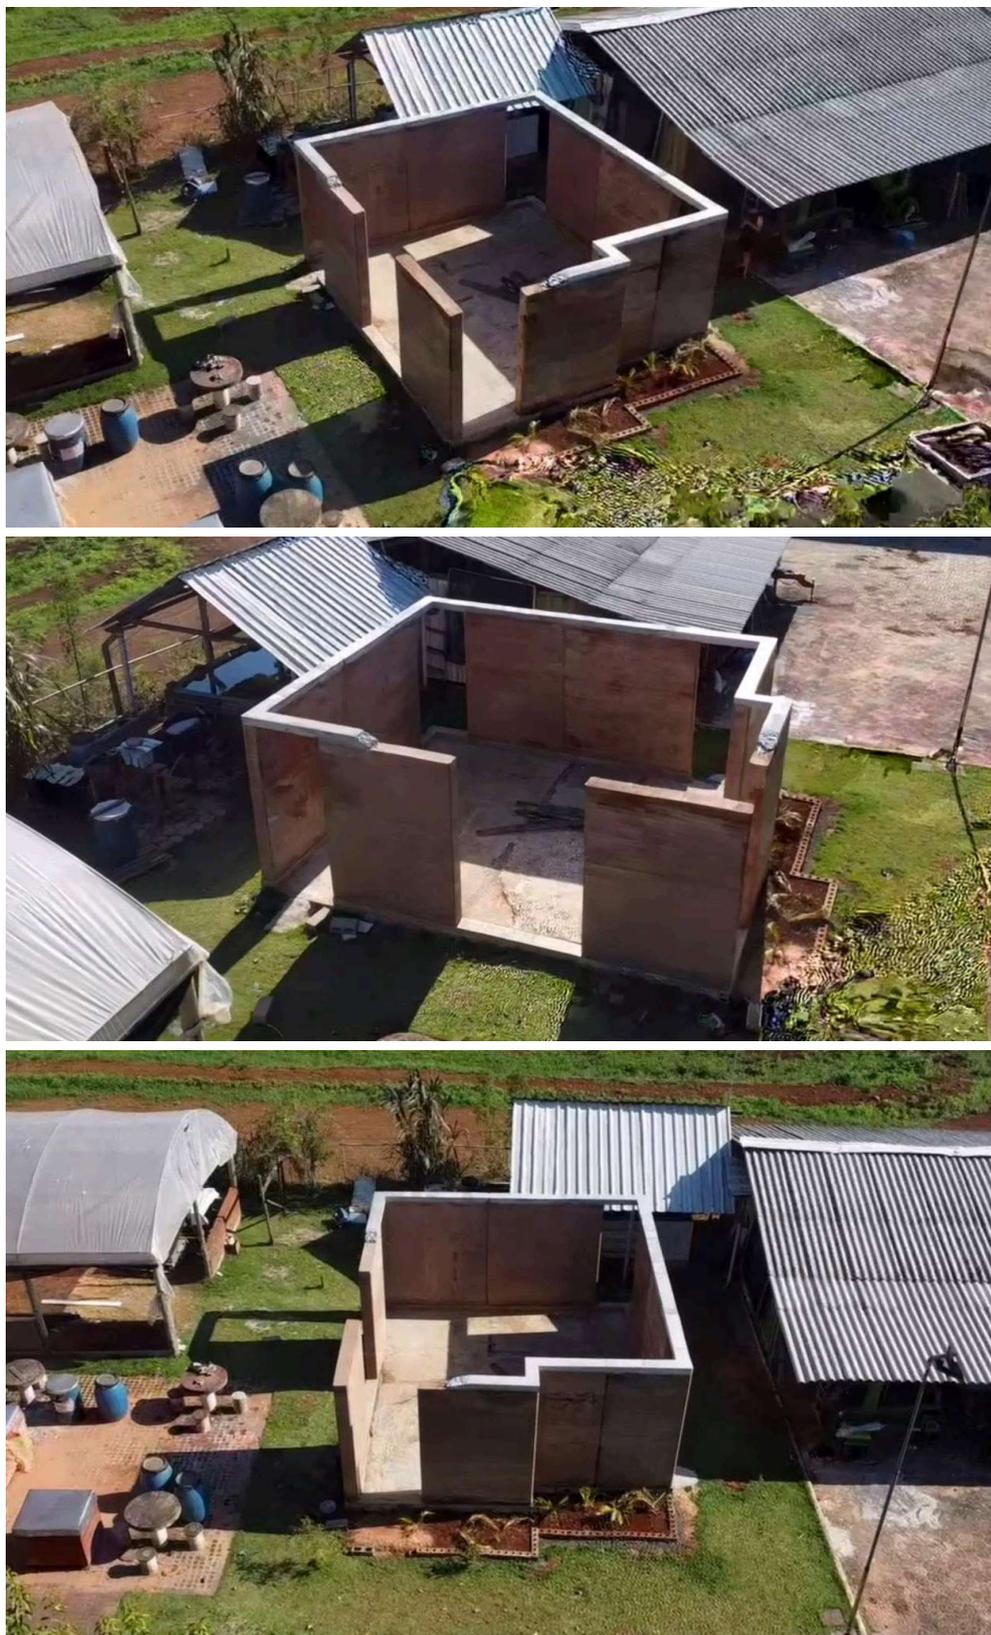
Paredes vistas de cima, em fase final de concretagem das vigas de respaldo. Fonte: autores.
